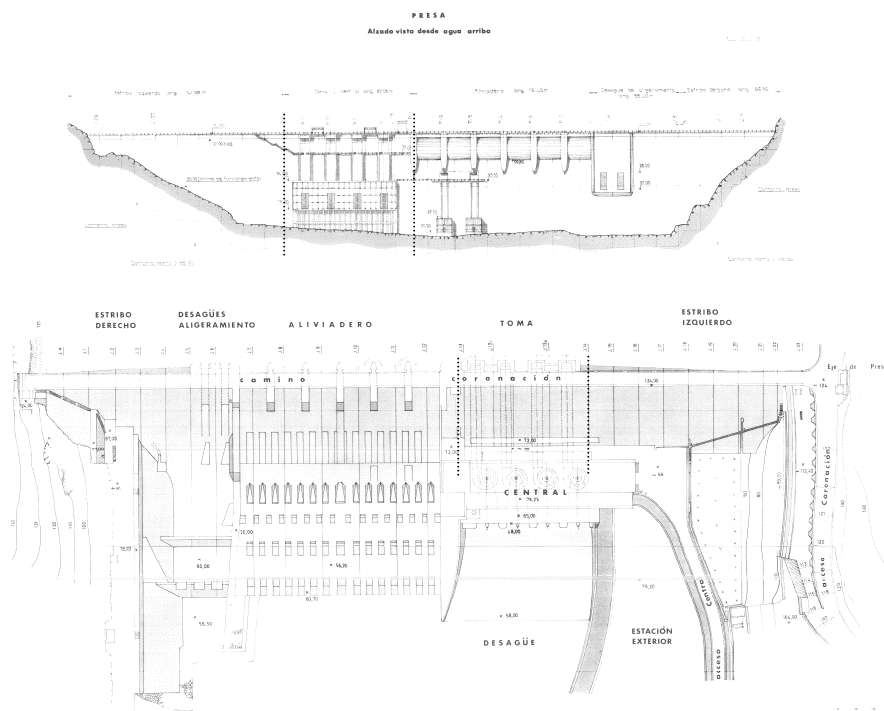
Alzado de la presa desde aguas arriba y planta de la misma
